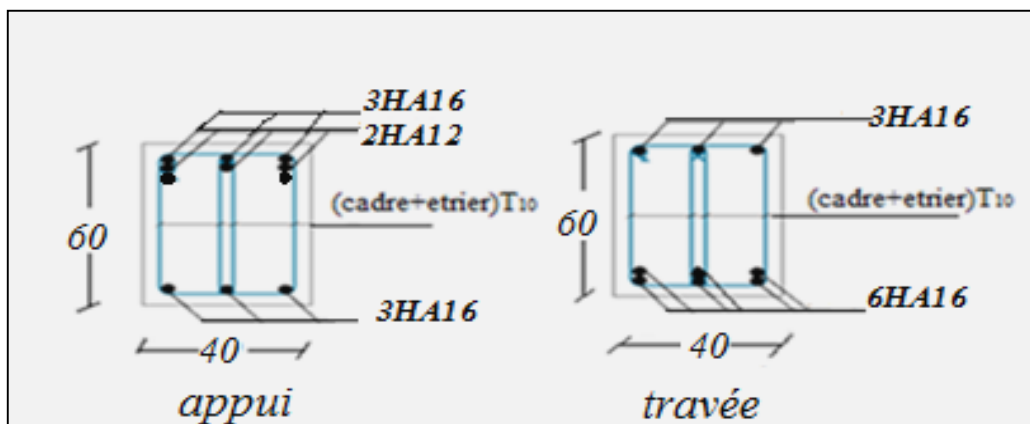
Schéma de ferrailage des poutres principales (étage).
